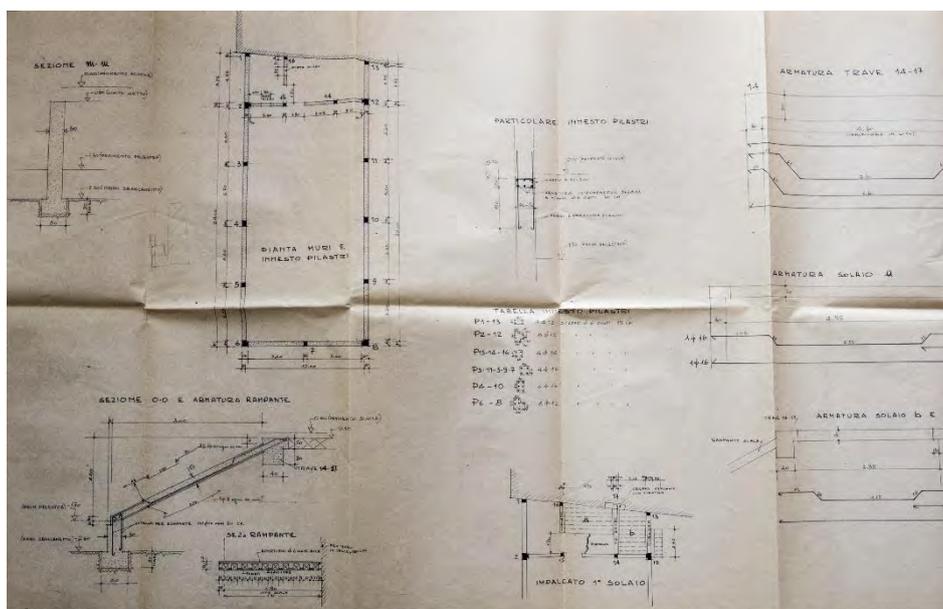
tavola strutturale del progetto originale (armatura pilastri, scala, travi e soletta ingresso)
